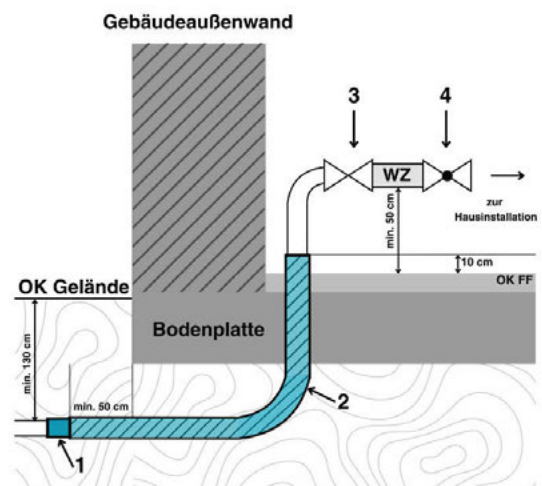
+ 13: Hauseinführung Trinkwasser in unterkellerten und nicht unterkellerten Gebäuden
